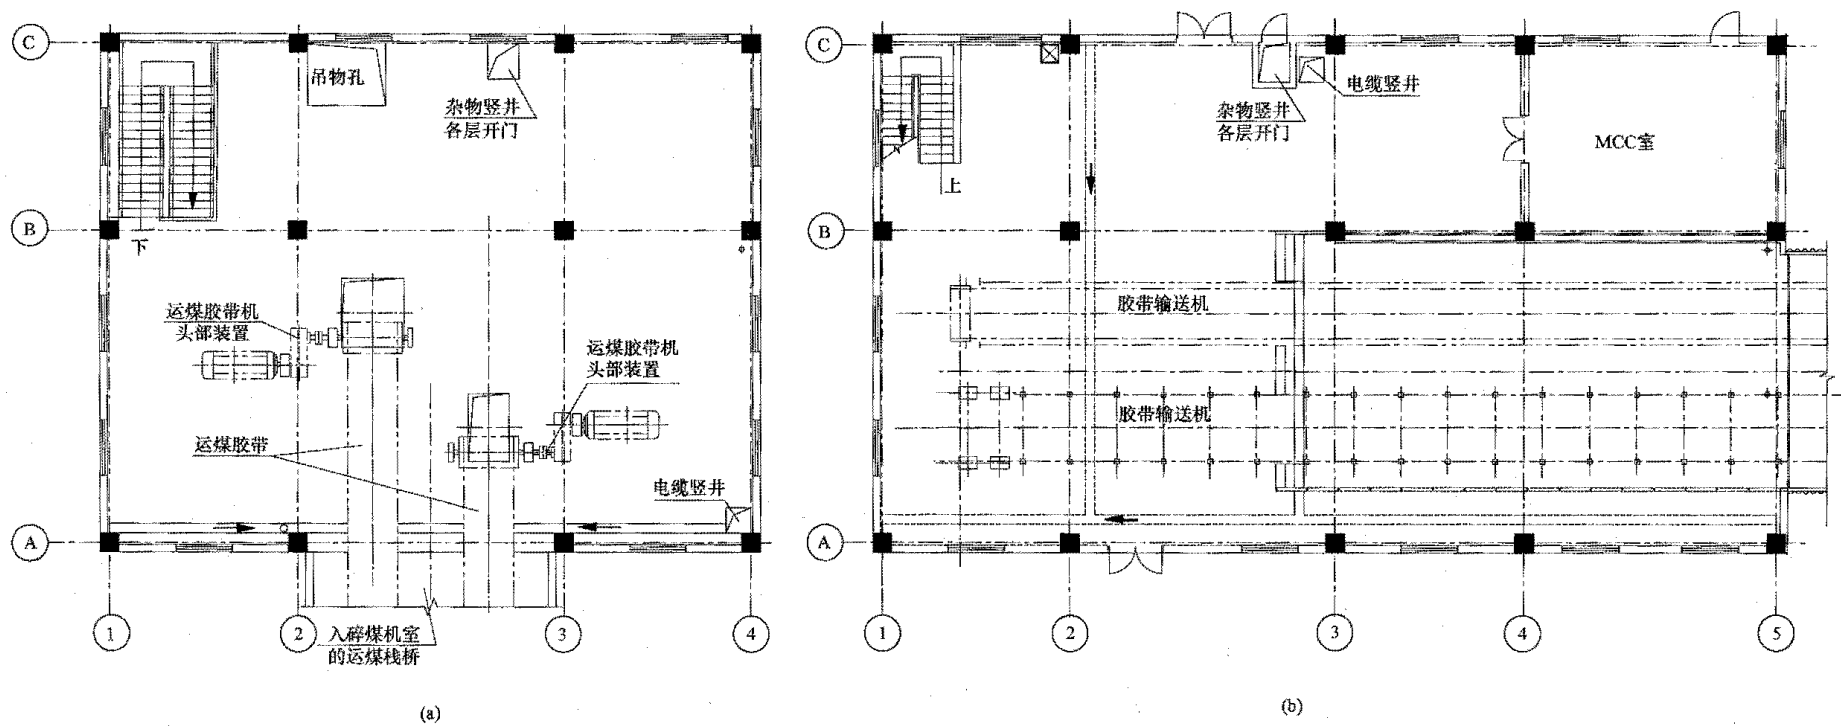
碎煤机平行于皮带的布置平面图 (二)
